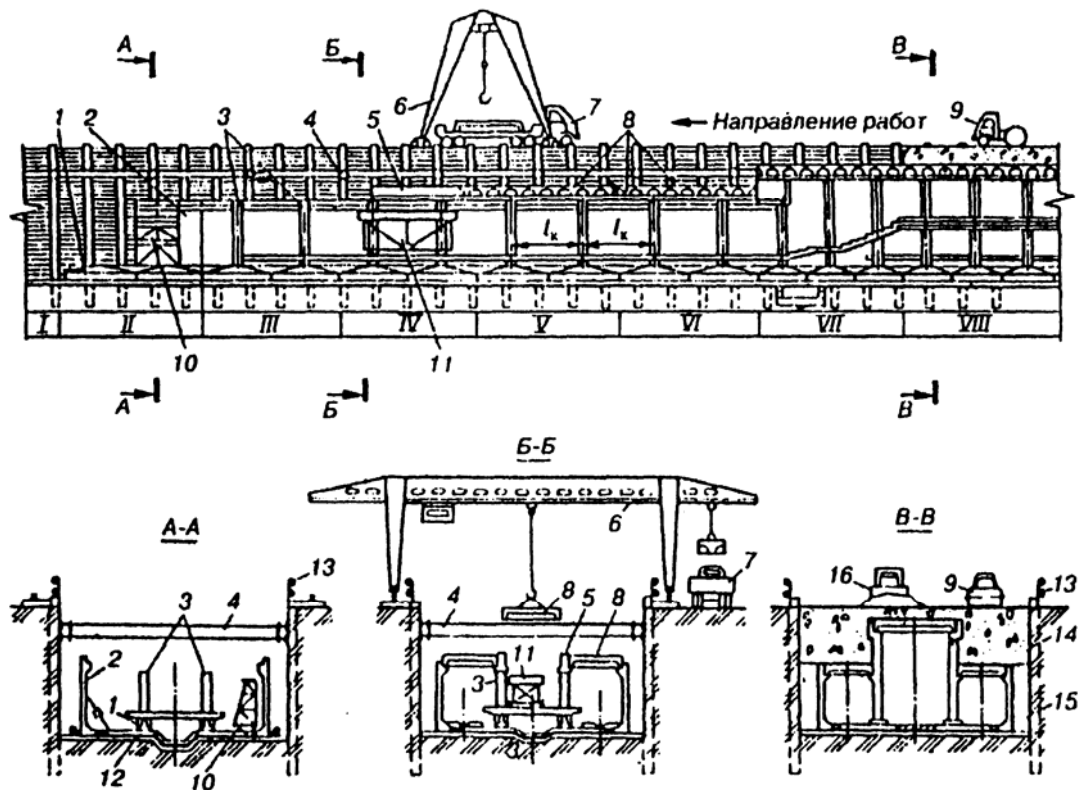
Схема зведення станції зі збірного залізобетону у котловані з пальовим кріпленням:
